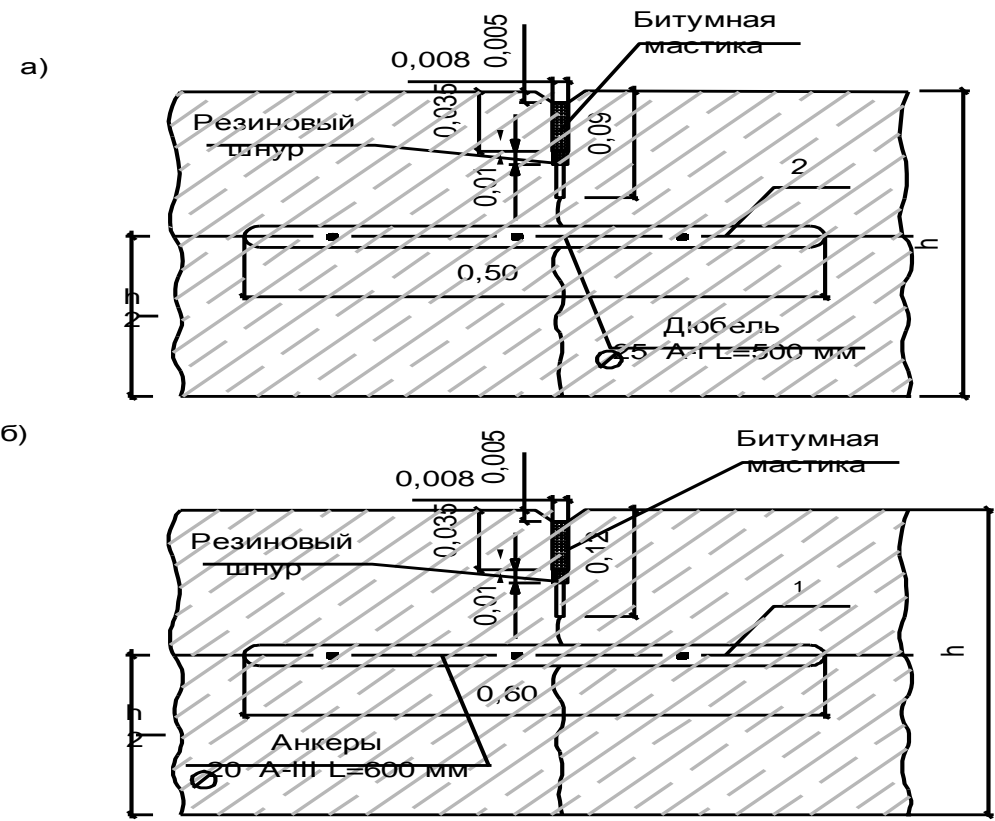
а) Разрез поперечного шва сжатия; б) Разрез продольного шва сжатия
